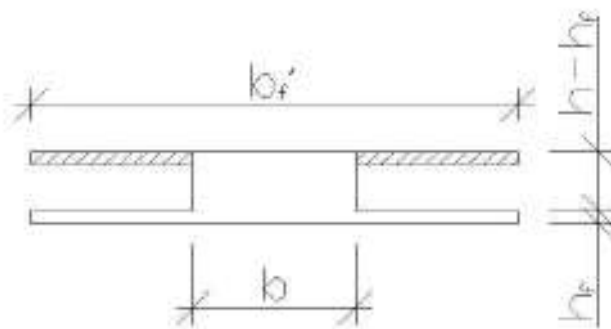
Схема к определению площади сечения без учета сжатой полки
